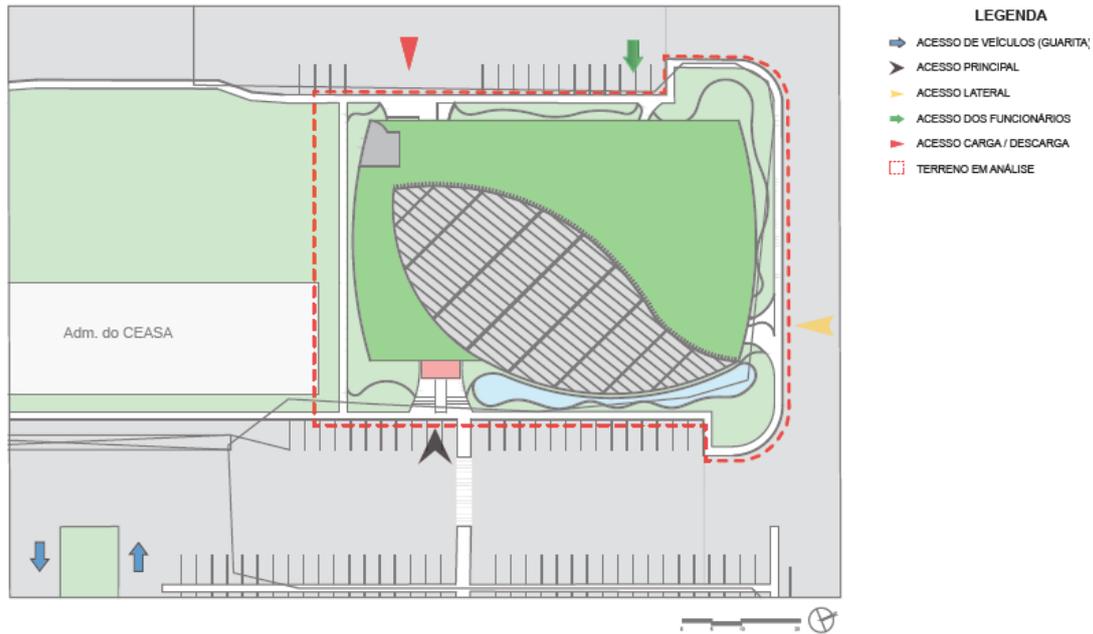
Planta de Implantação. Fonte: Acervo do autor.
